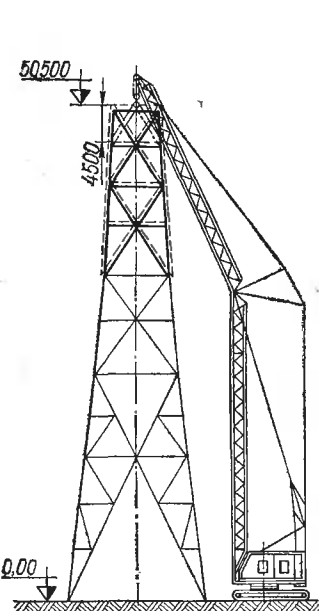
Схема монтажа башни самоходным стреловым краном.
